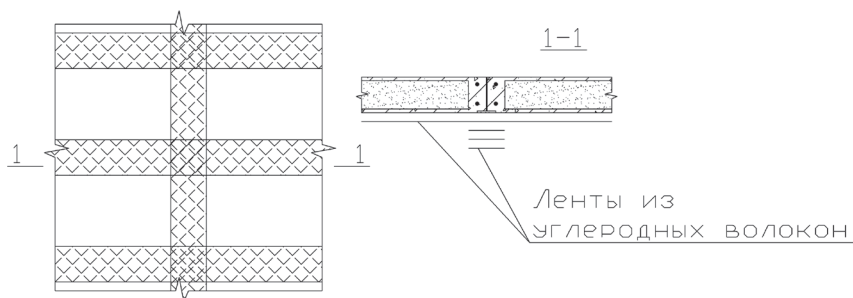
Схема усиления перекрытия после непроектных нагрузок
